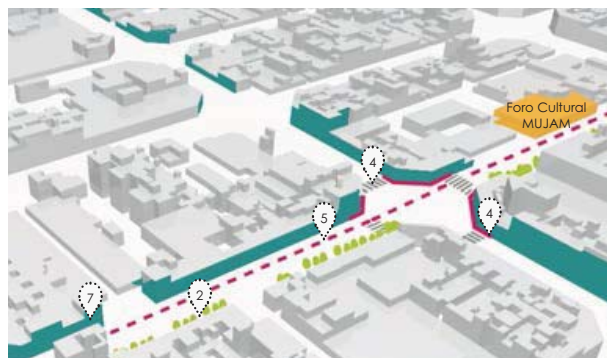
Isométrico Plan general, calle Dr. García Diego
